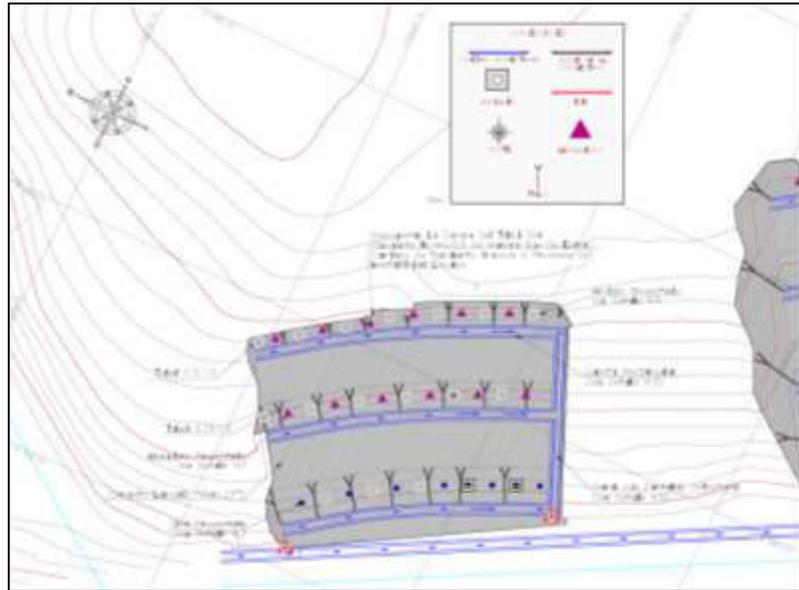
Obras propuestas en planta Sitio 1A
